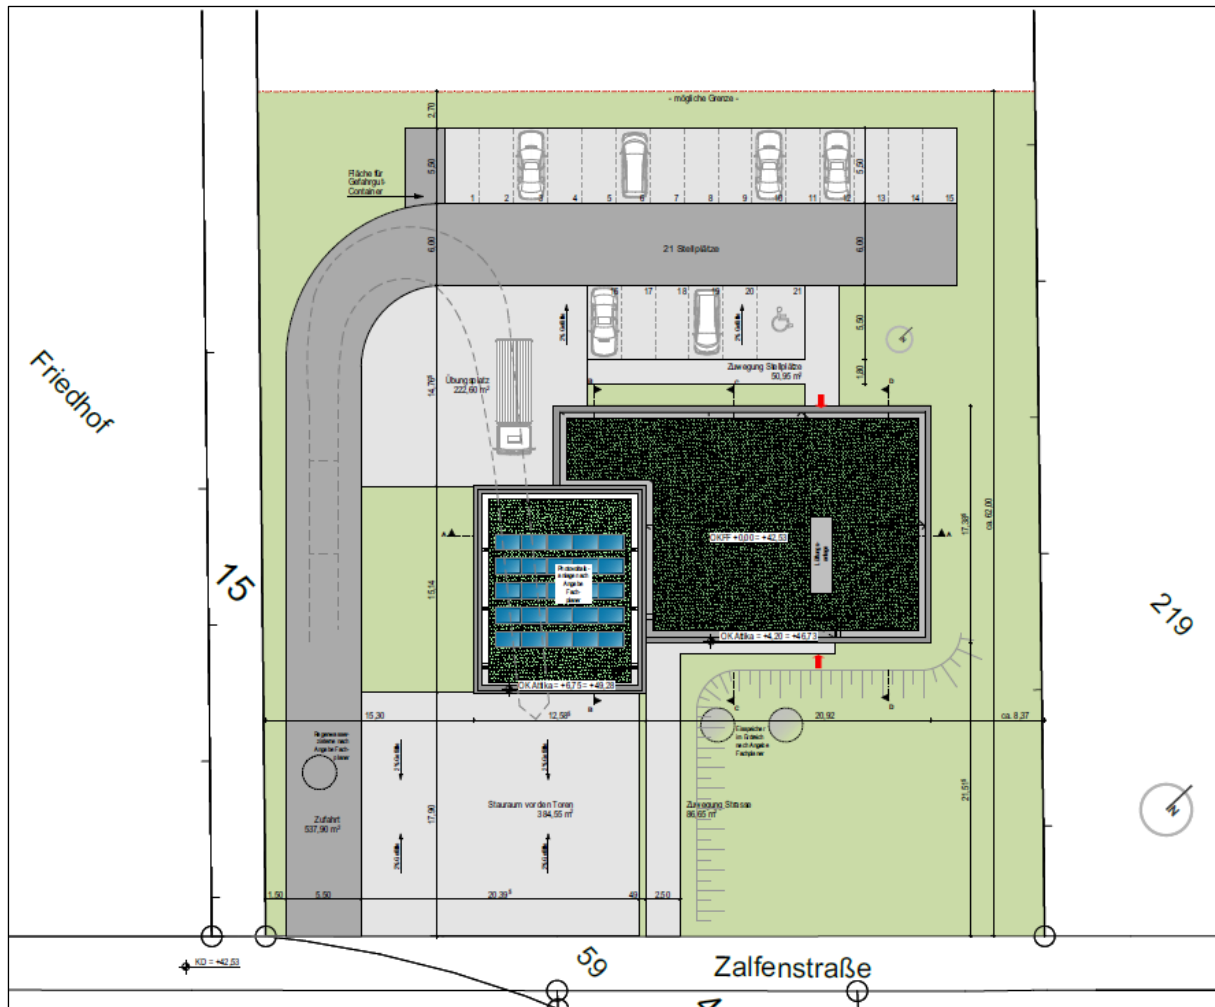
Städtebauliches Konzept, Lageplan; (Baues Architekten, 25.03.2022)
